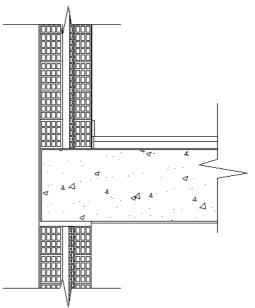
Encuentro de fachada con forjado, enfoscado. Fuente: Edición propia
